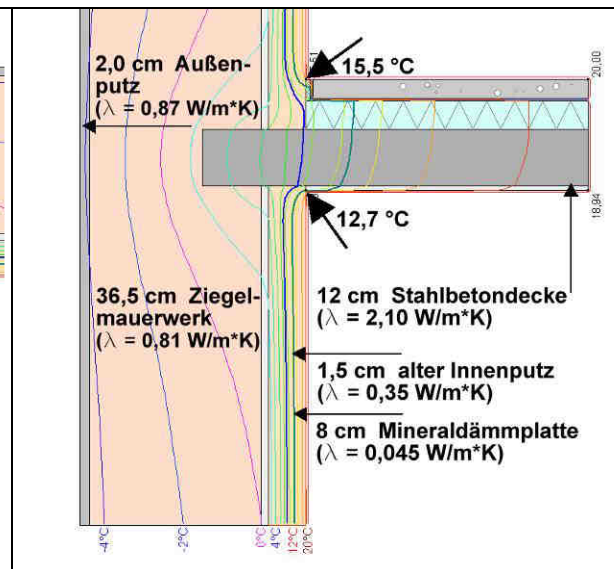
Vertikalschnitt: Einbindende Stahlbetondecke
